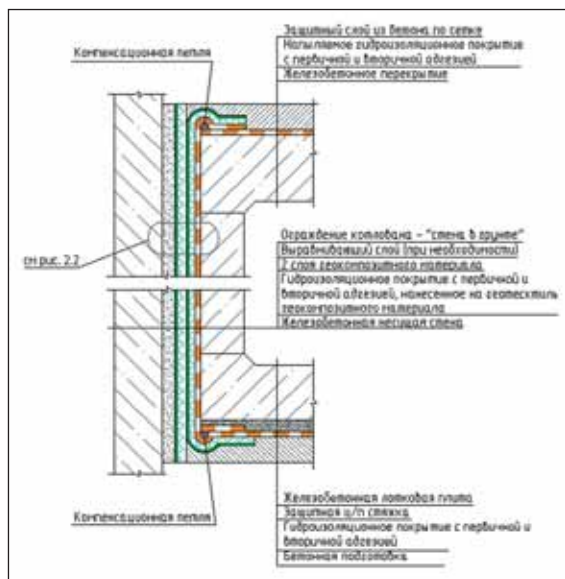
Схема устройства гидроизоляционной системы при открытом способе работ без пауз для обратной засыпки грунтом [12]
